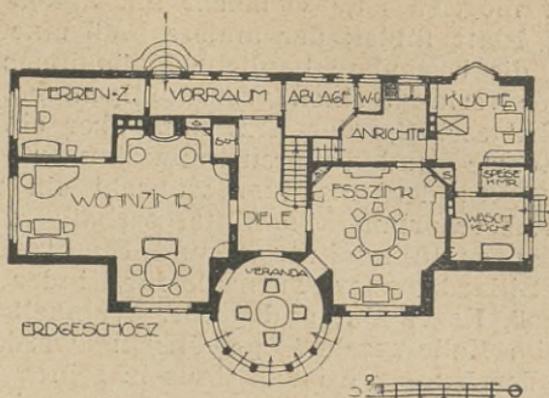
74. Eingeschossiges Haus (Künstlerhaus) mit völlig ausgebautem Dachgeschoß
